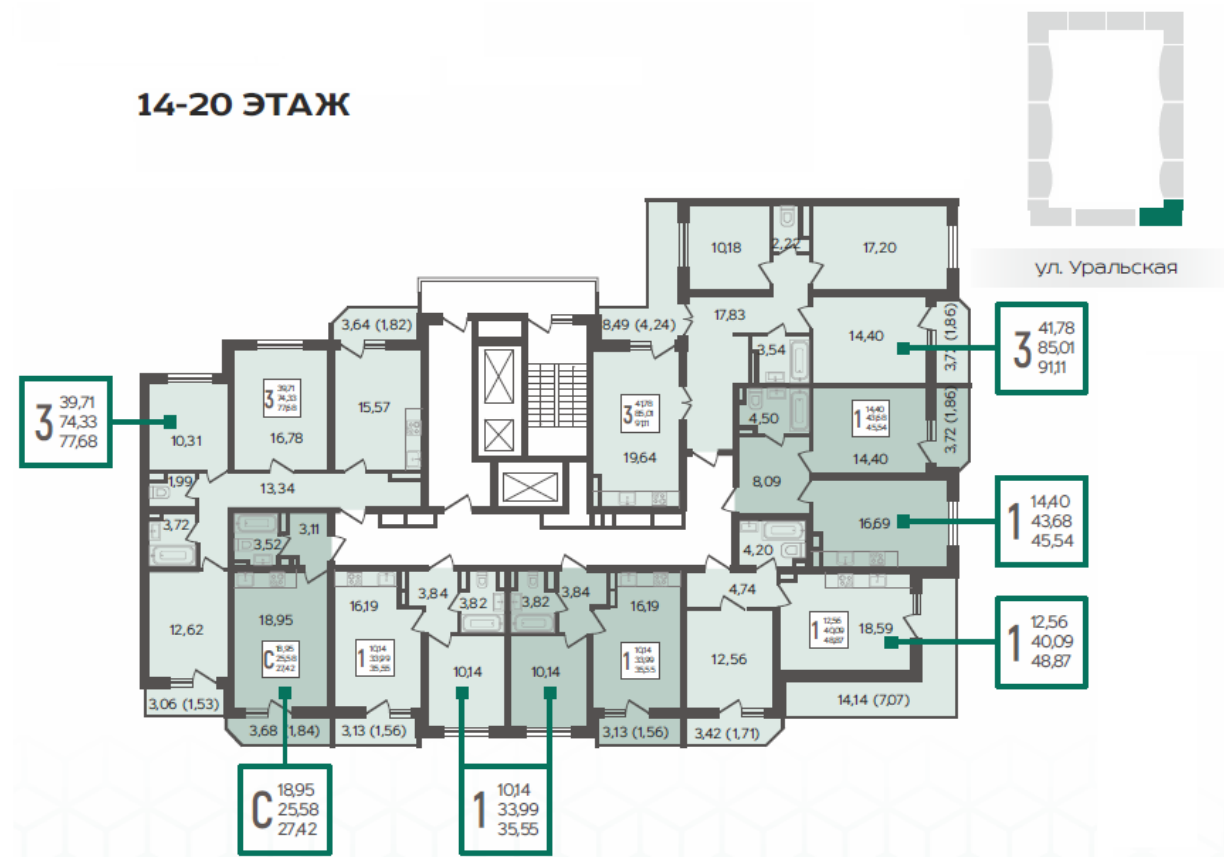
Типовой план 14-20 этажа БС-12 ЖК URAL
